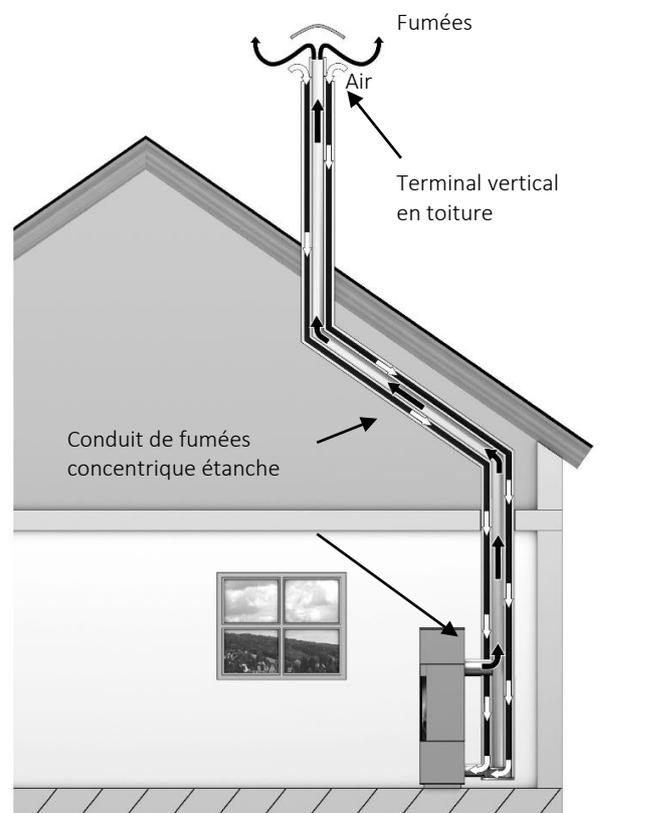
Installation étanche Zone 2 ou Zone 1 ; (selon la hauteur du conduit)
